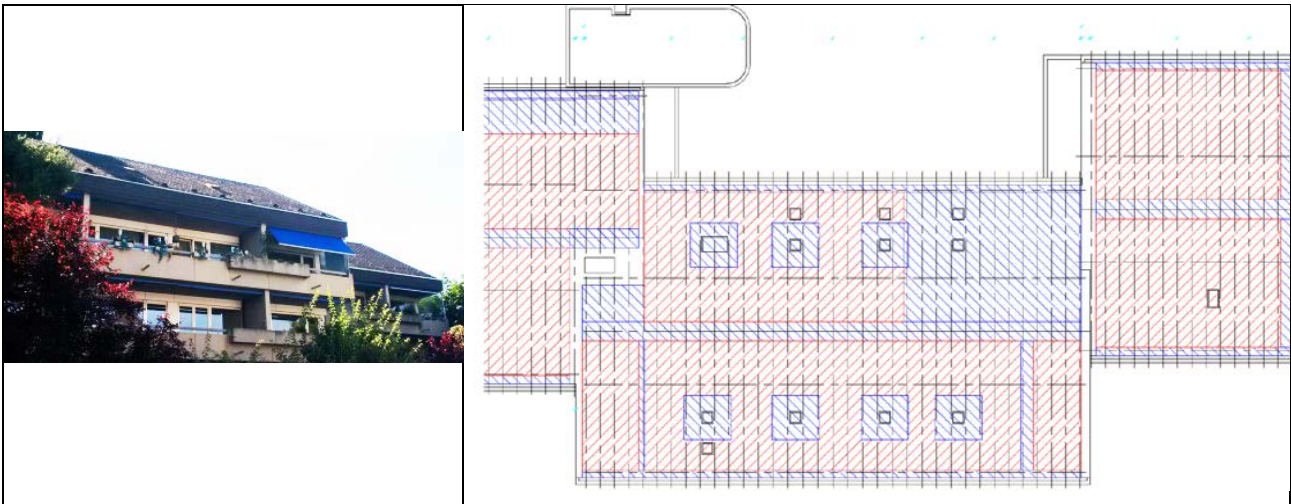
Aussenansicht (links) und Dachplan der PV-Anlage (rechts), Alterssiedlung Drei Brunnen, Riehen.
